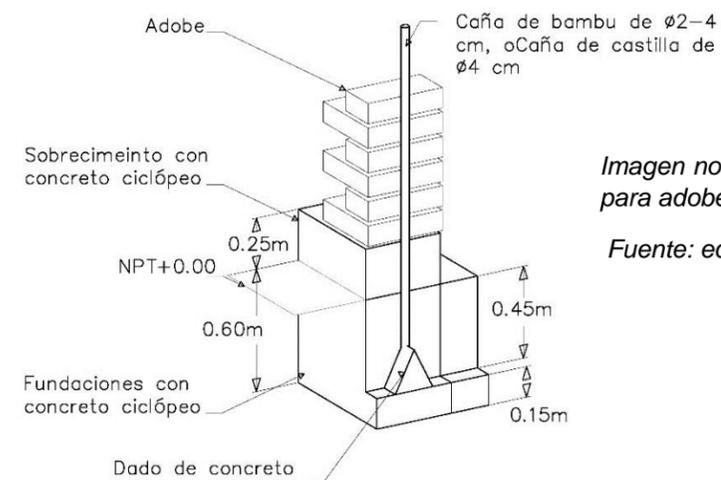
Detalle de fundaciones para adobe reforzado con bambú.
